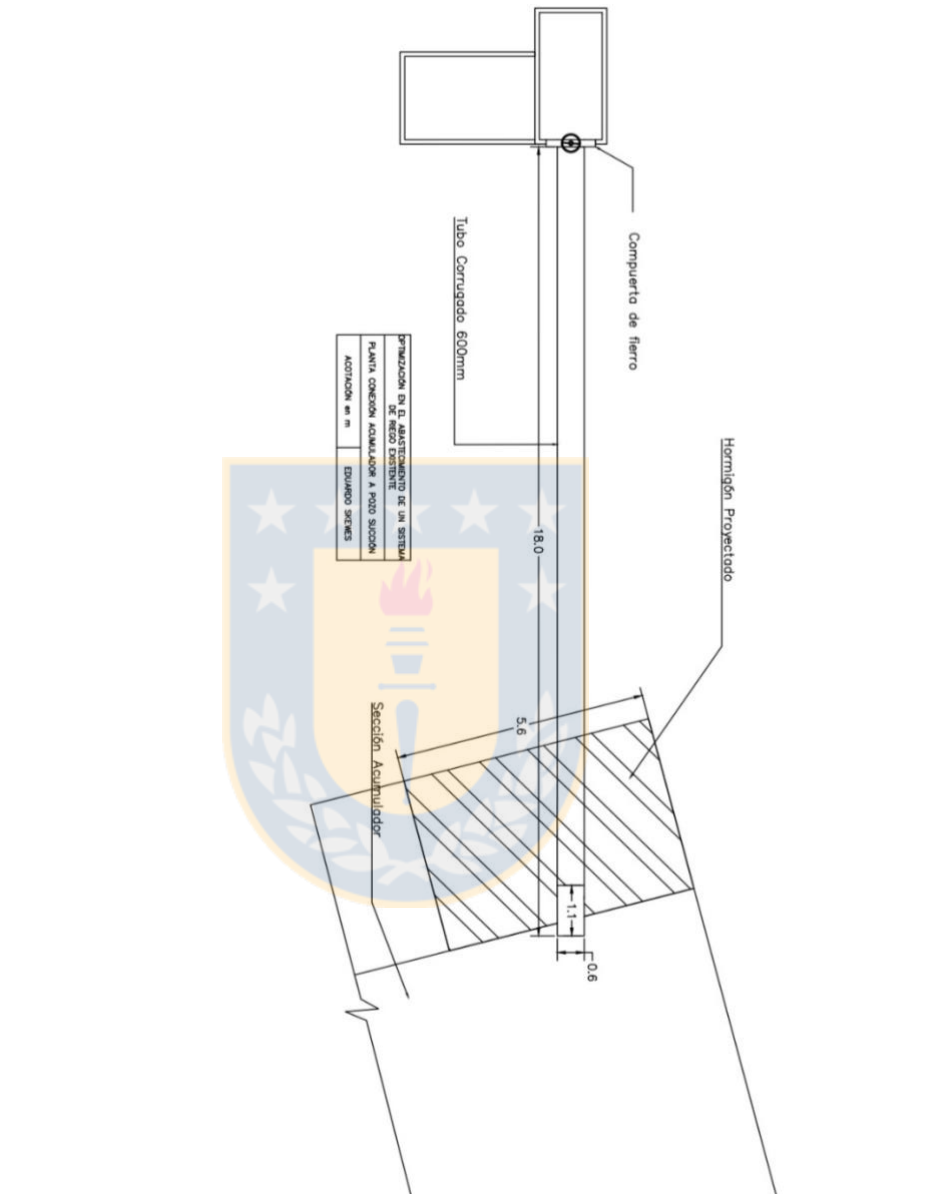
Vista de planta de conexión entre acumulador con succión del pivote. Fuente: Elaboración propia.
